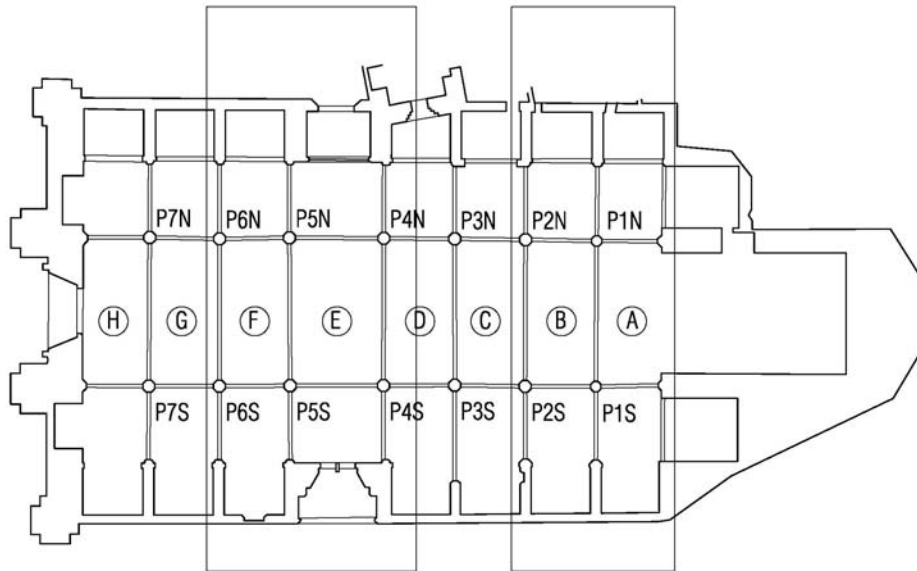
Planta de la catedral con los tramos levantados y la notación utilizada en la identificación de tramos y pilares
